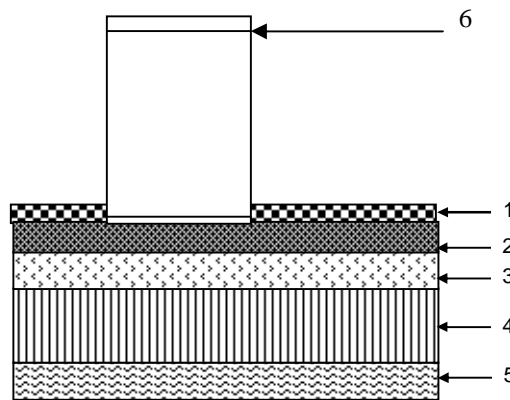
Coupe transversale du plancher terrasse inaccessible
